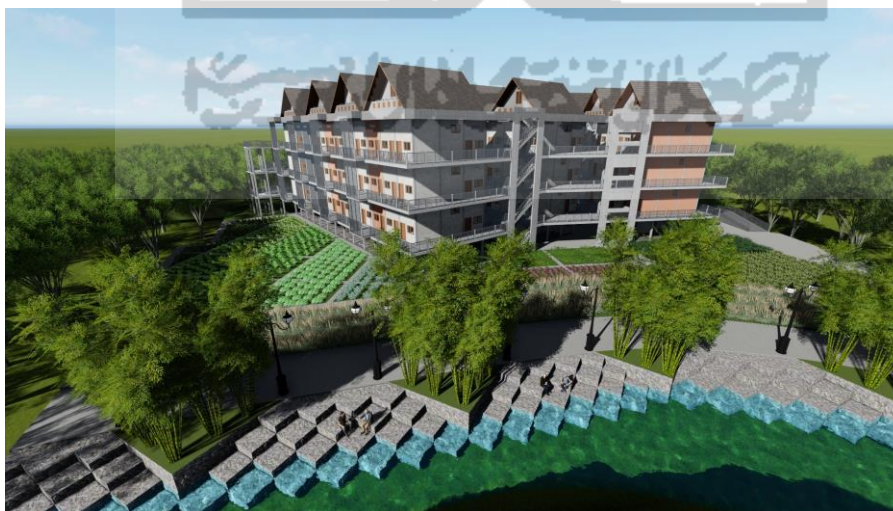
Rancangan Sistem Struktur Bangunan
